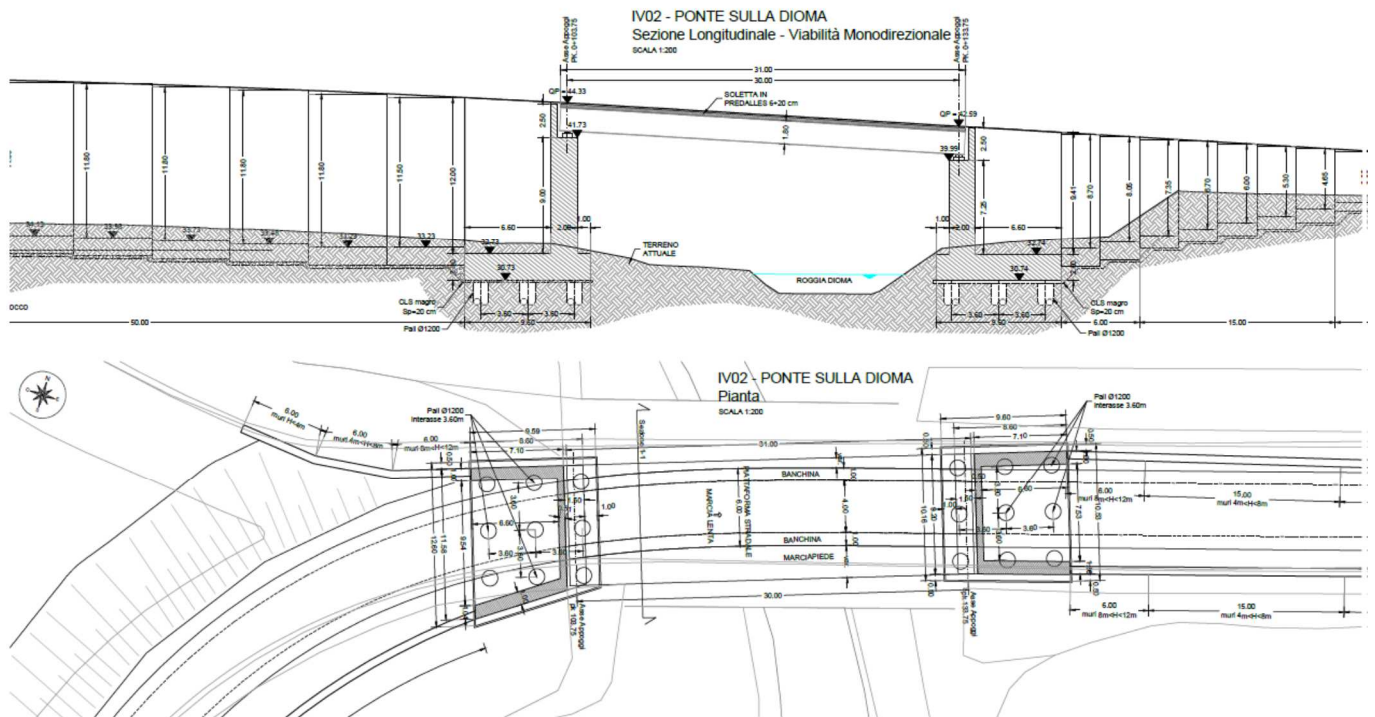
Planimetria e Profilo del Ponte sulla Dioma
